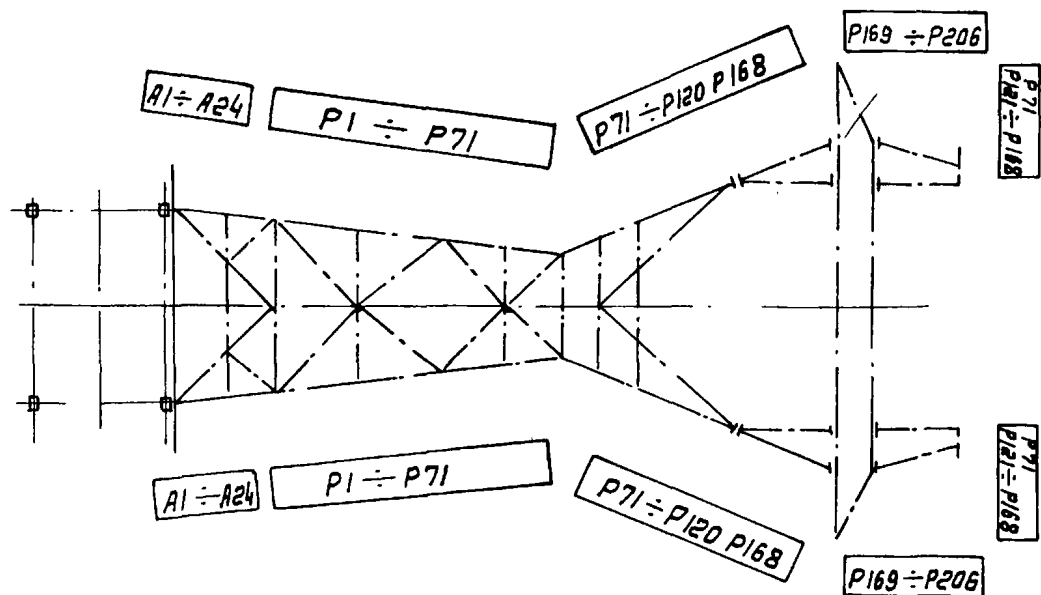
План расположения пакетов с деталями опоры P1+5 или P2+5
